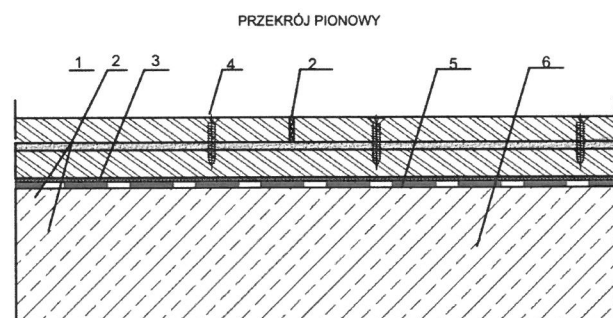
Przekroje przez stropy drewniane – przykłady rozwiązań
